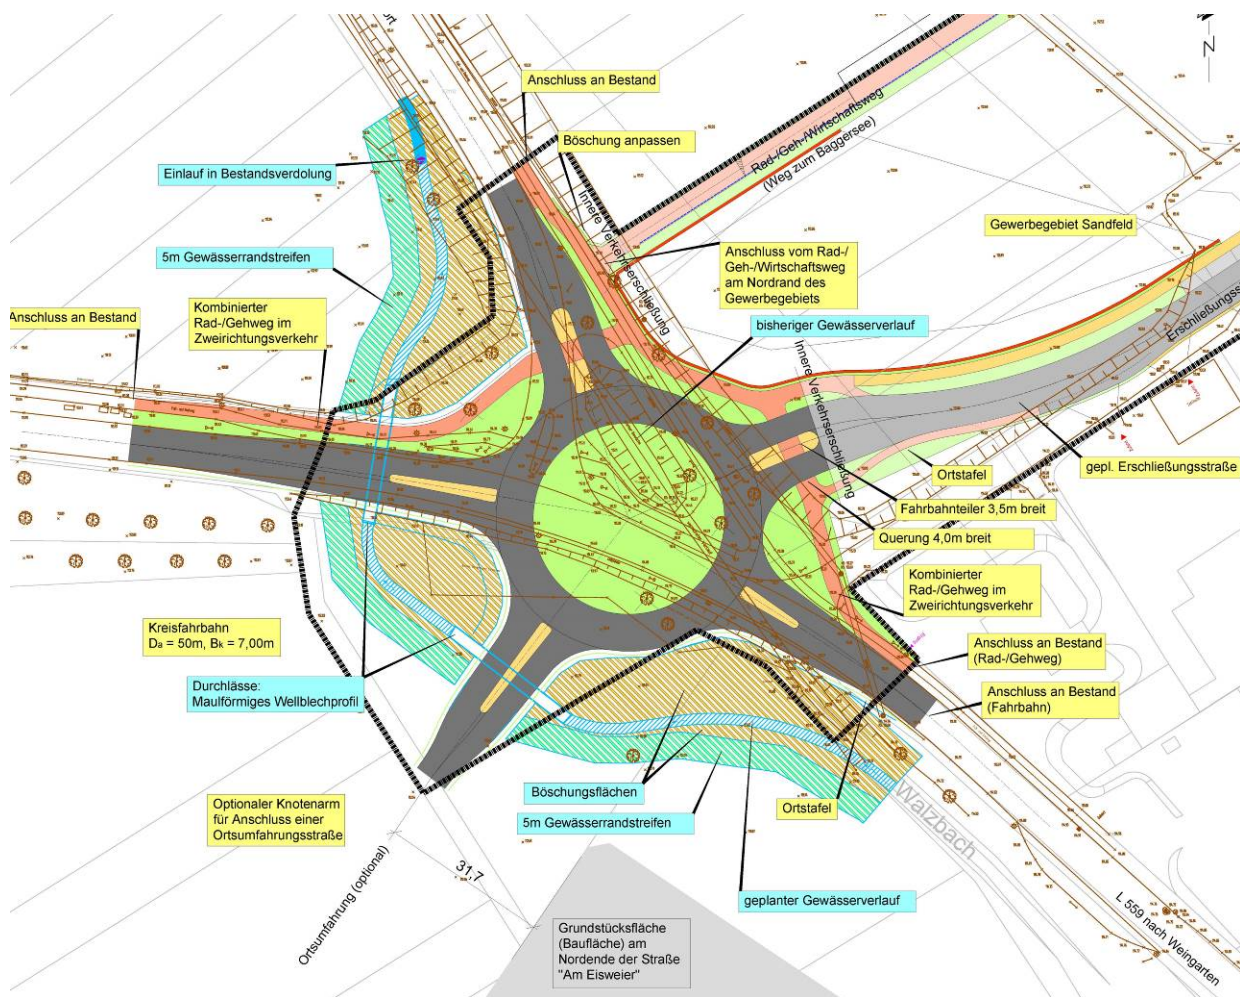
Planung Kreisverkehr, Quelle: Wald + Corbe.
